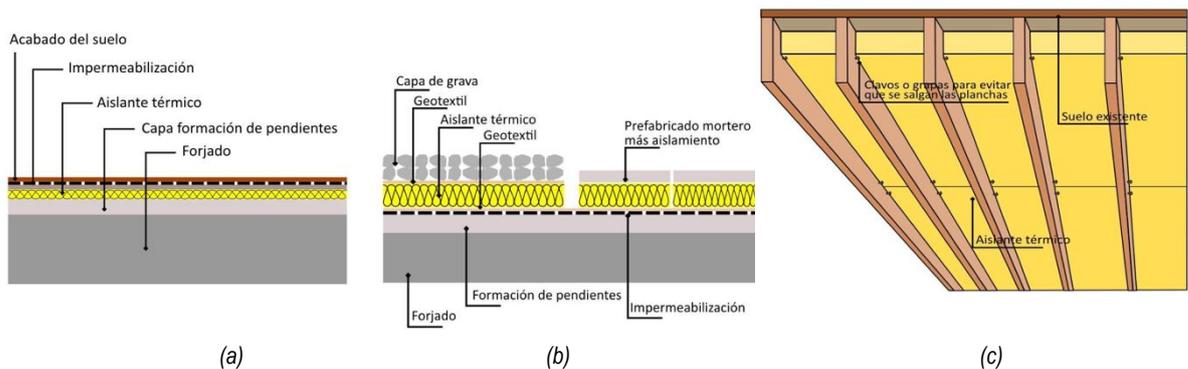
Cubierta plana: solución caliente con aislante térmico debajo de la impermeabilización (a). Cubierta plana: solución invertida con aislante térmico encima de la impermeabilización (b). Aislamiento por la cara inferior (c) (ETRES Consultores, 2011).
